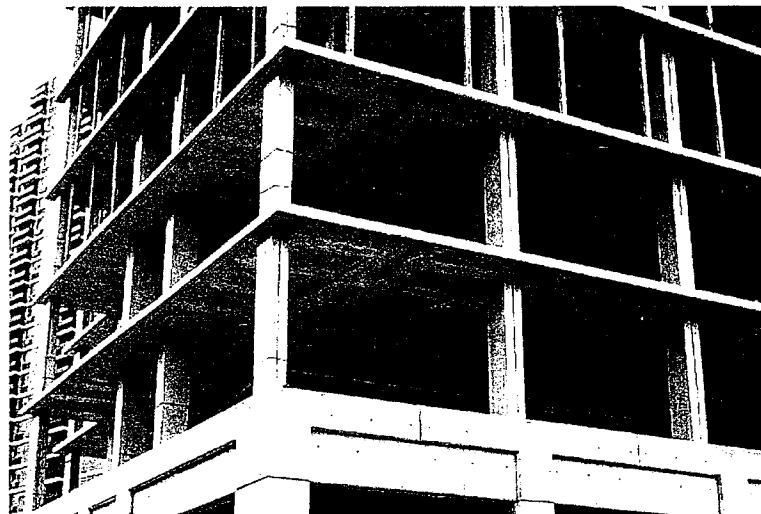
Edificio de losas planas sin vigas (Flat Plate)
